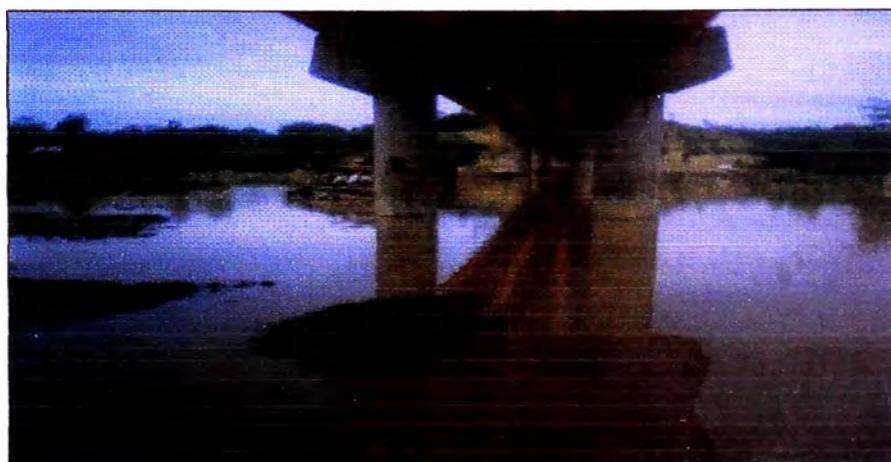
Vigas Metálicas colocadas en todo el Tramo.
